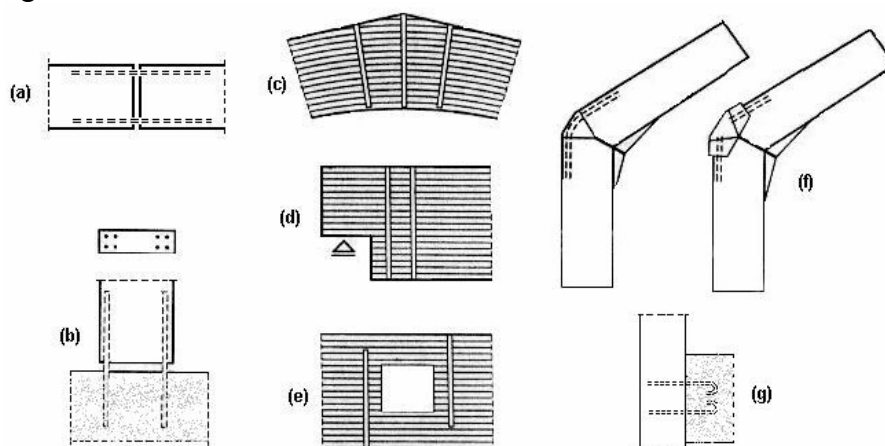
Exemplos de aplicação de barras de aço coladas em estruturas de madeira.
